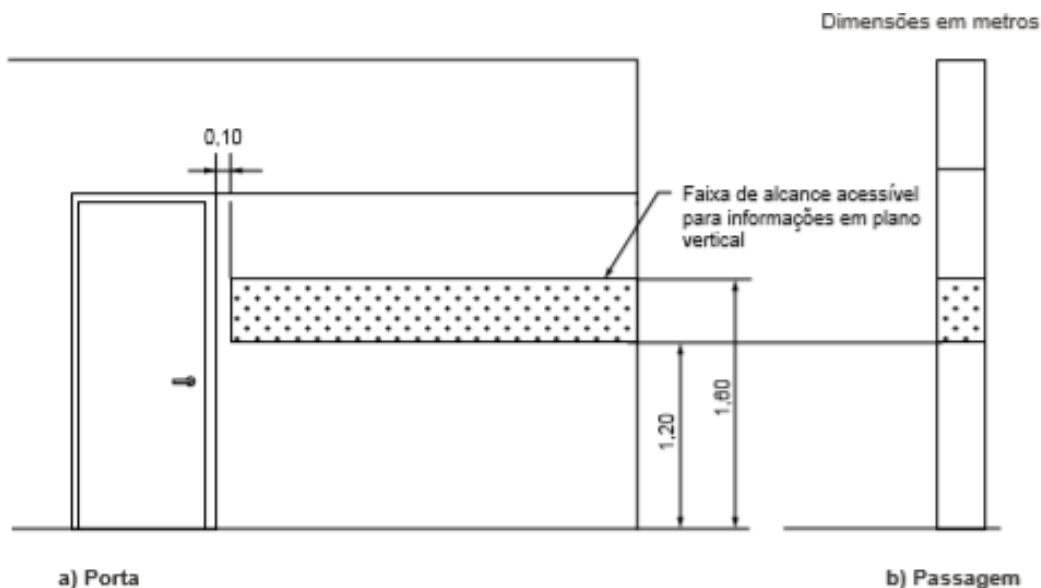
Sinalização de portas e passagens – Faixa de alcance acessível
